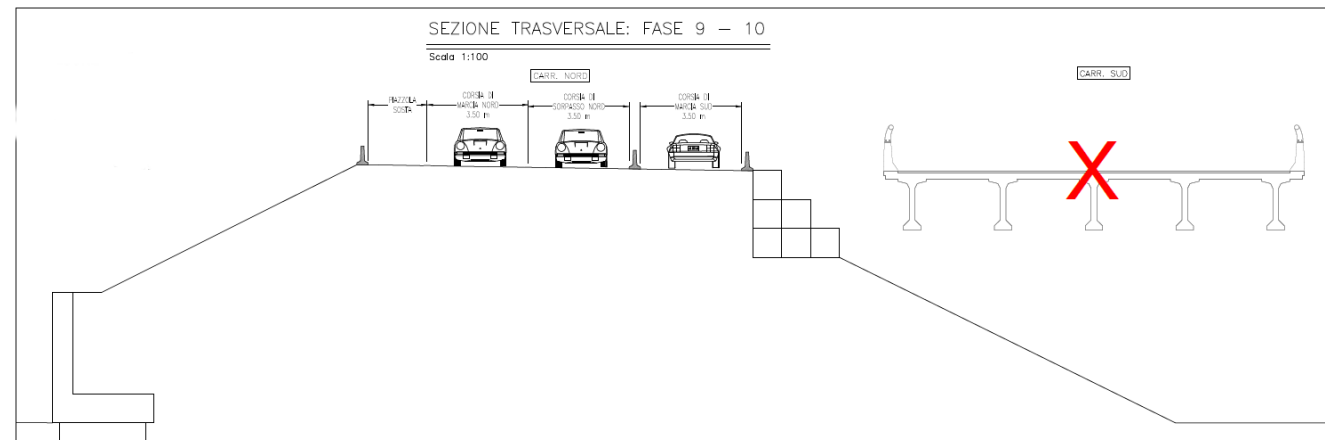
Sezione trasversale: Fasi 9 e 10
